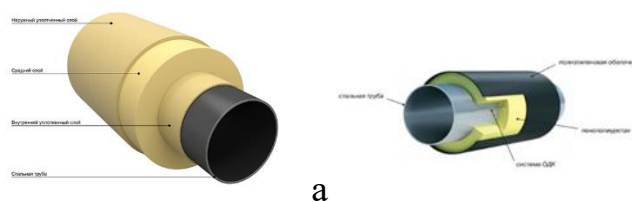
а) Конструкция трубопровода в ППМ изоляции; б) Конструкция трубопровода в ППУ изоляции
